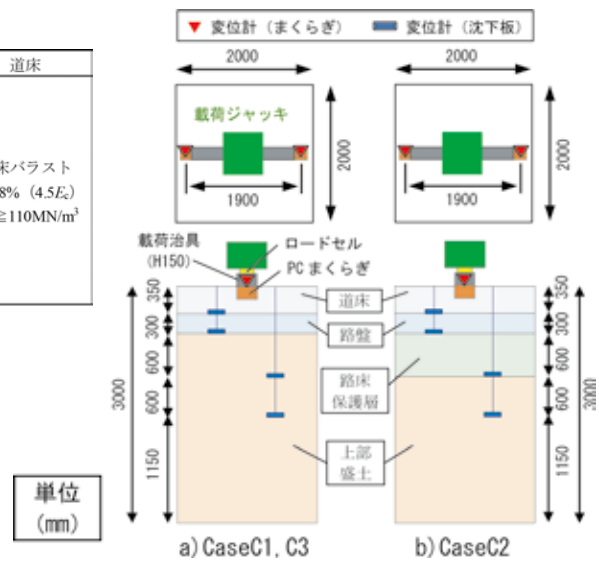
模型仕様および計測器の配置 (上：平面図，下：断面図)
